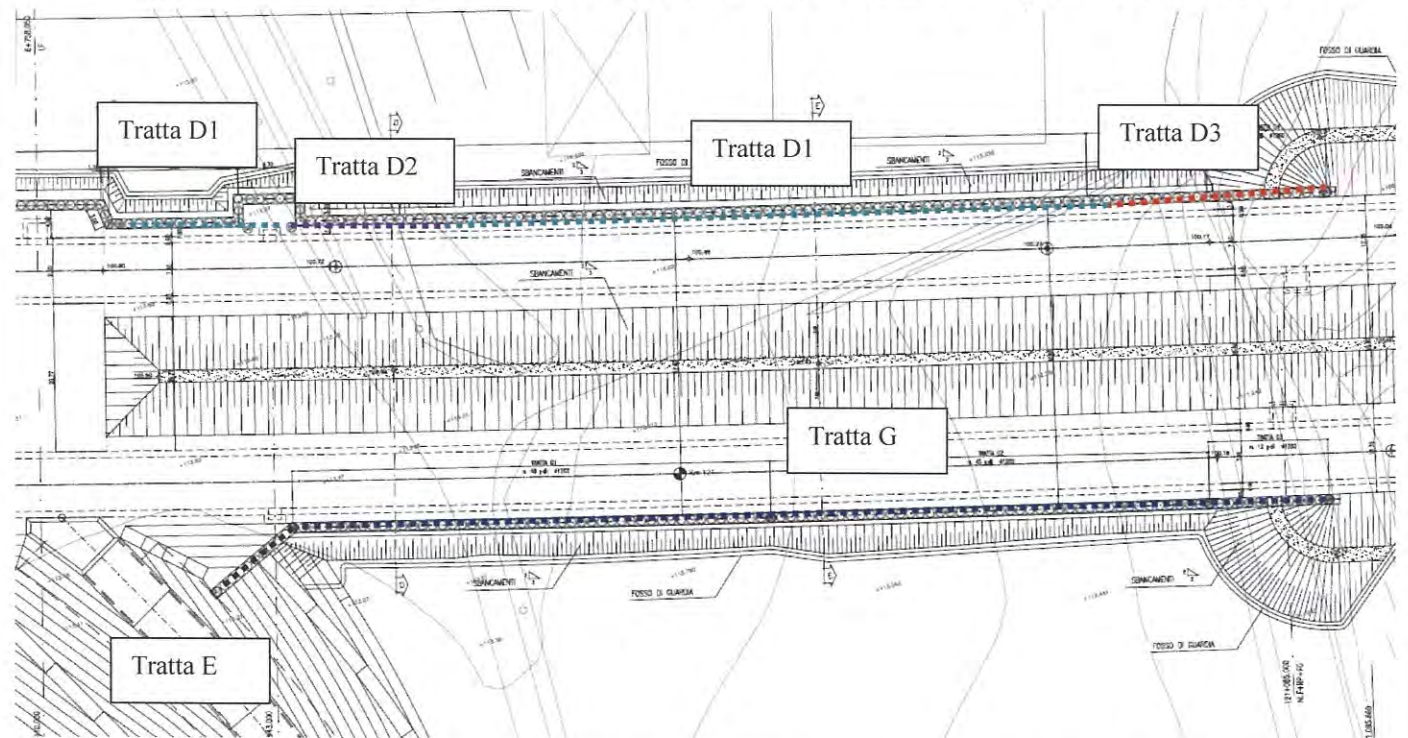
Planimetria con indicazione delle diverse tratte di calcolo in corrispondenza degli edifici dell'Azienda Serraglio
